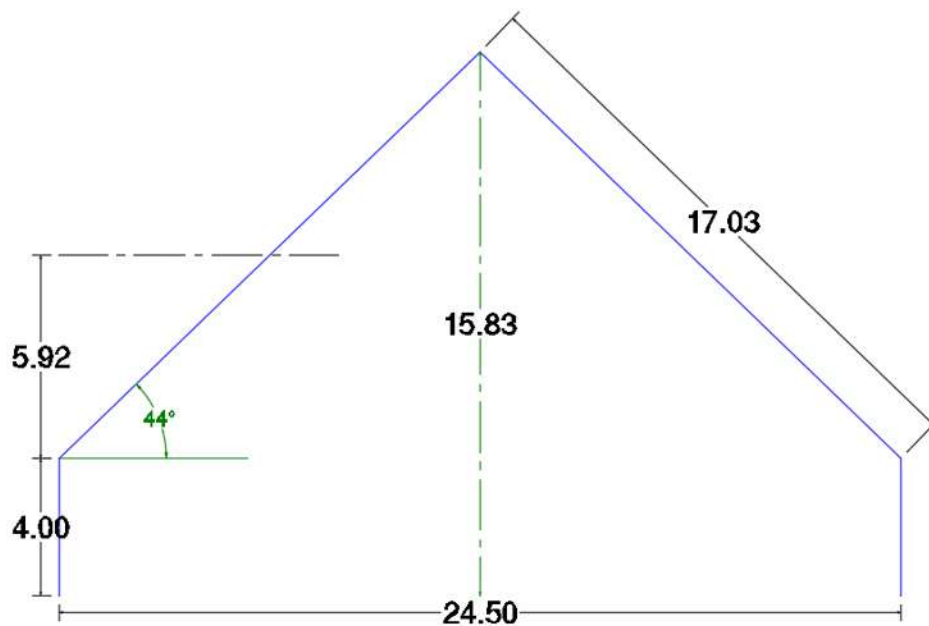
(a) Ubicación de ángulo de diseño y dimensiones en cubierta aislada, (metros)
